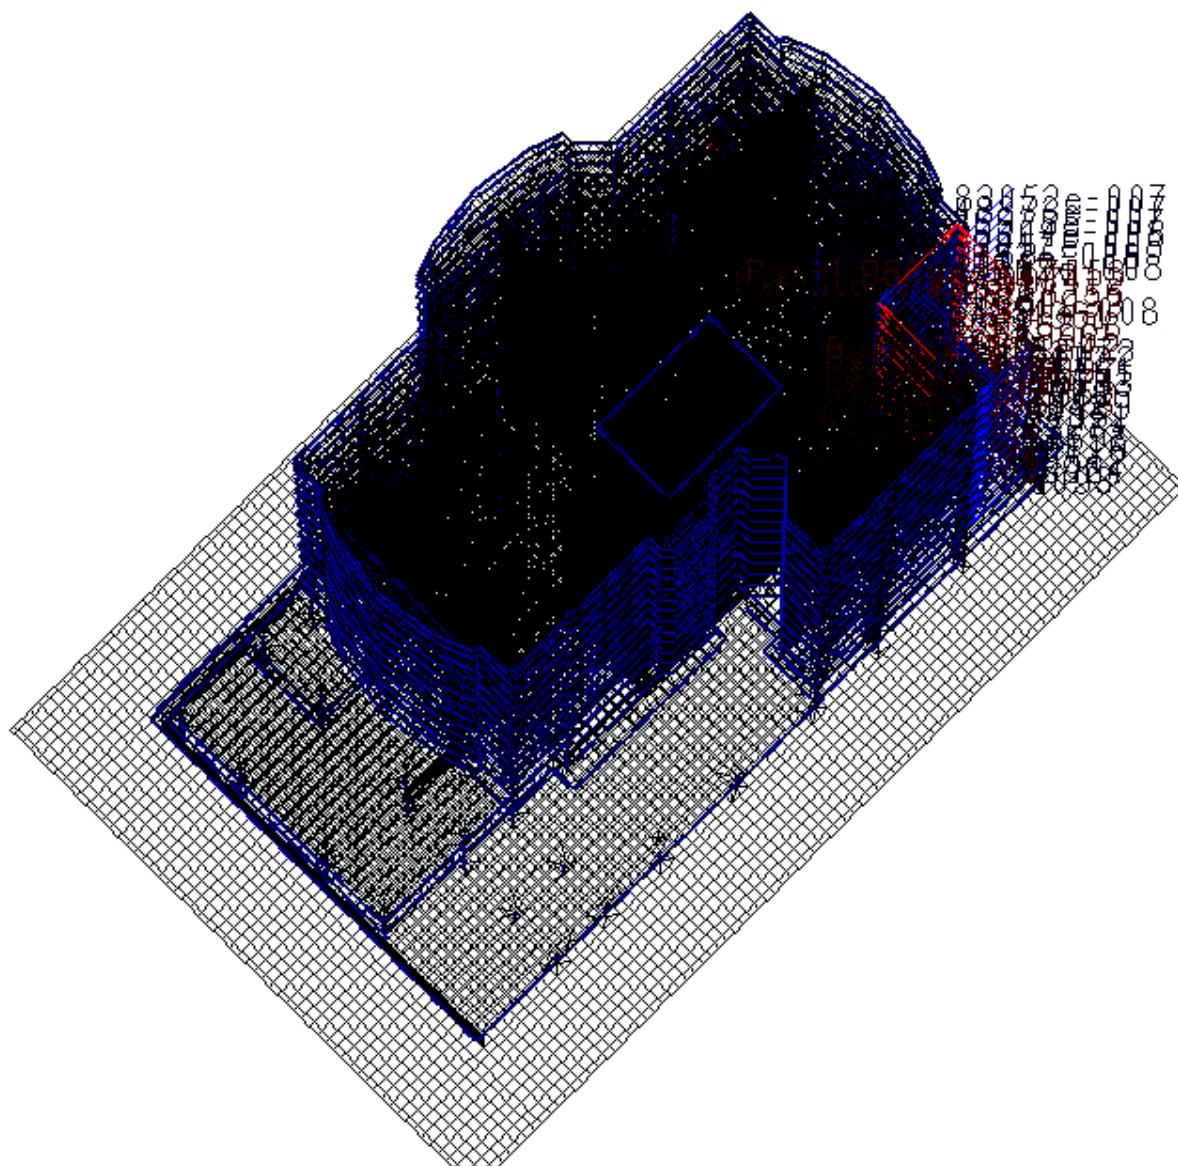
Узловая ветровая нагрузка – ветровой «карман 2» (нагружение 9)
